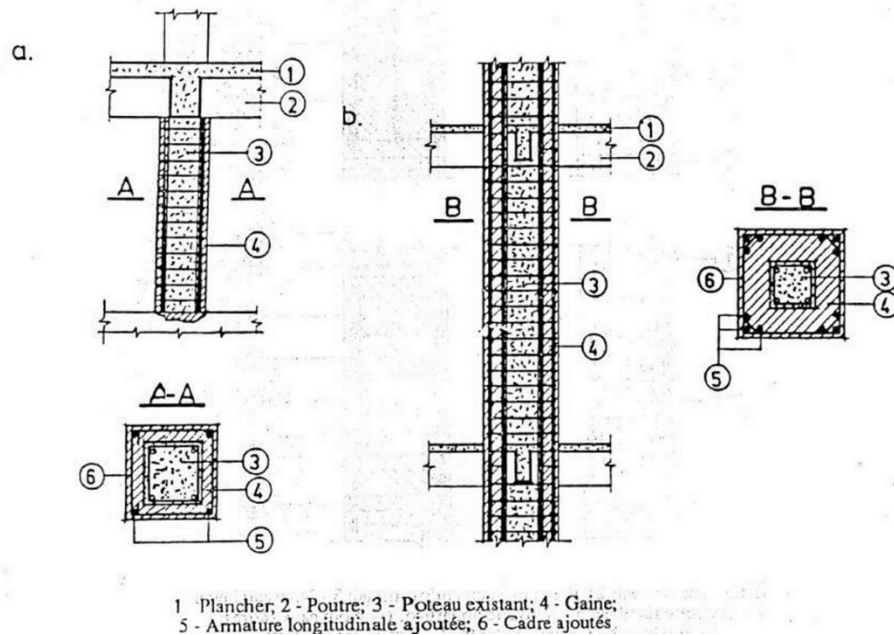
Gainage en béton armé pour poteaux rectangulaires [3]
